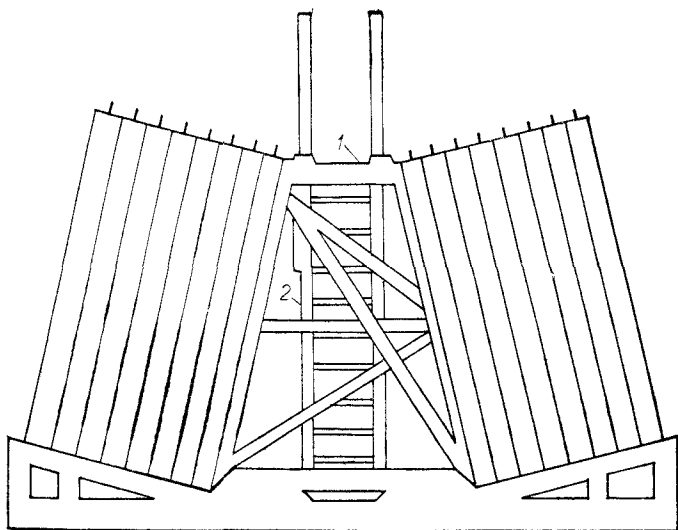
Стеновые панели, гипсобетонные перегородки, элементы солнцезащиты складывают вертикально в пирамиды:
